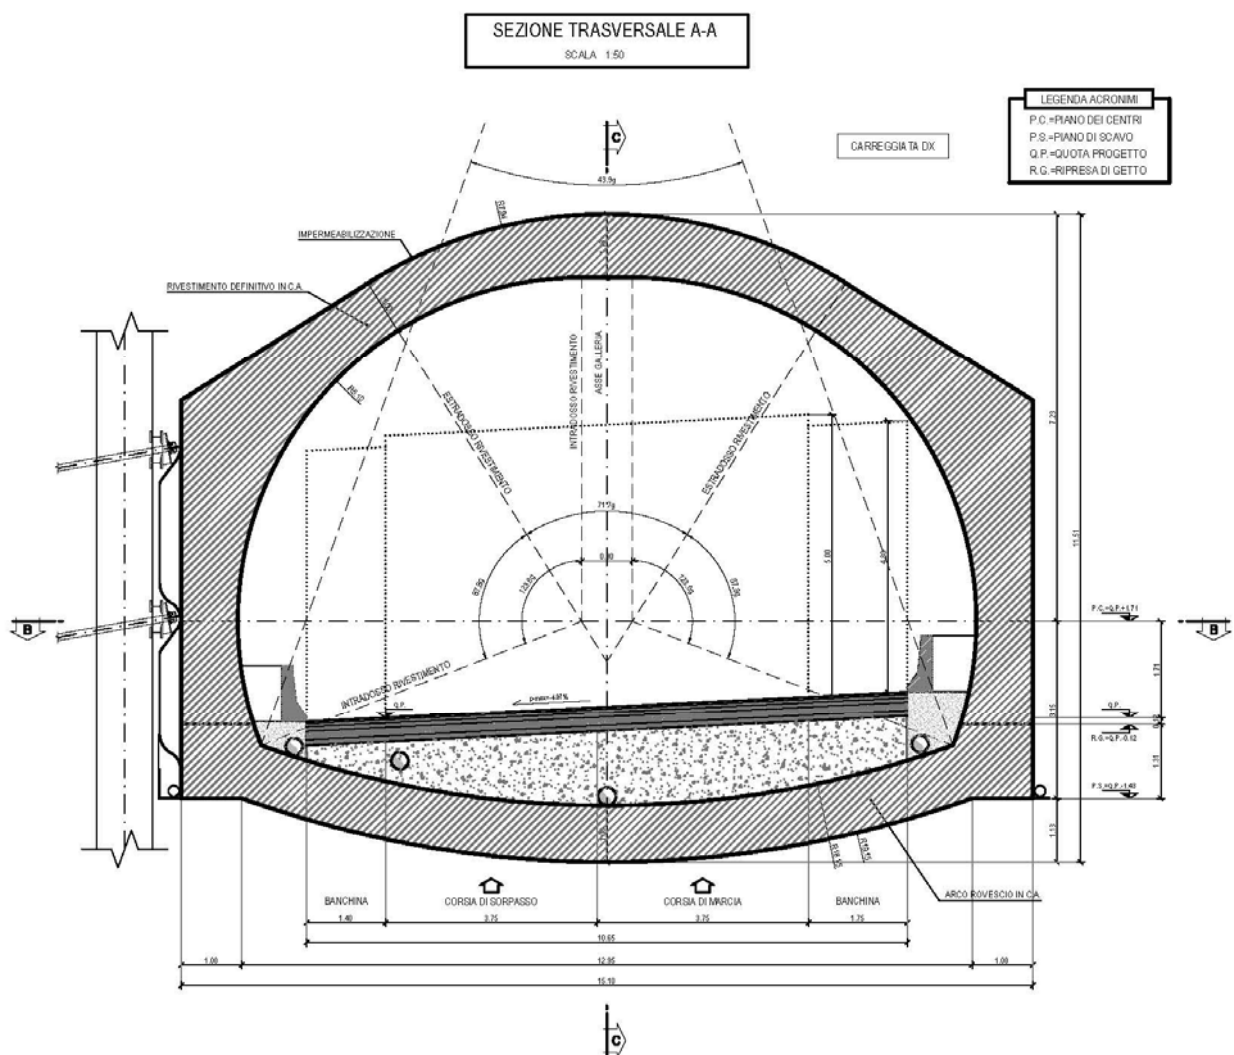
Sezione tipo corrente della galleria artificiale.
